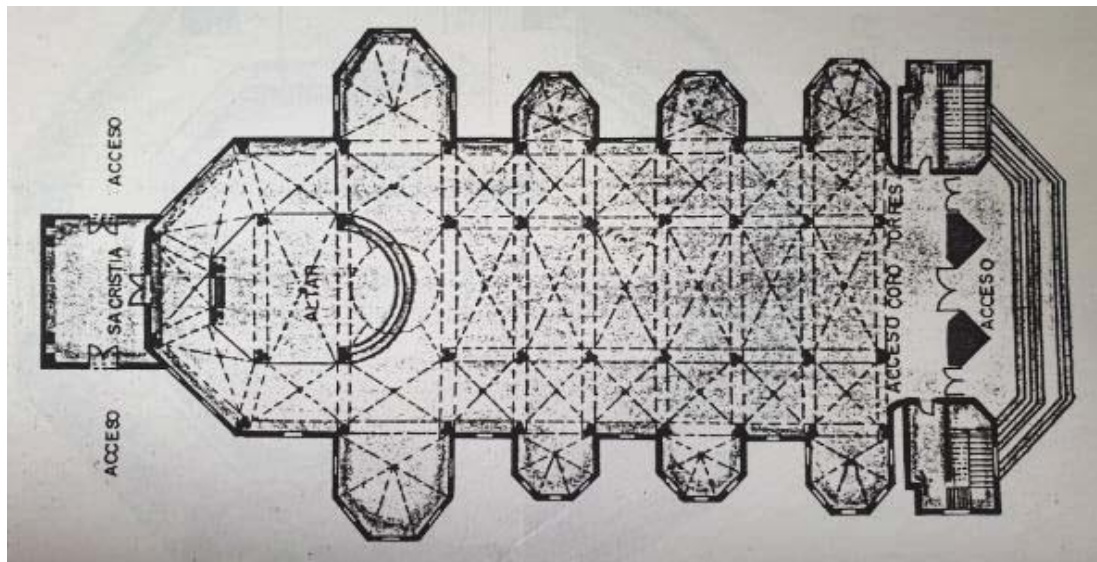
Planta de la Iglesia Santa Bárbara.
